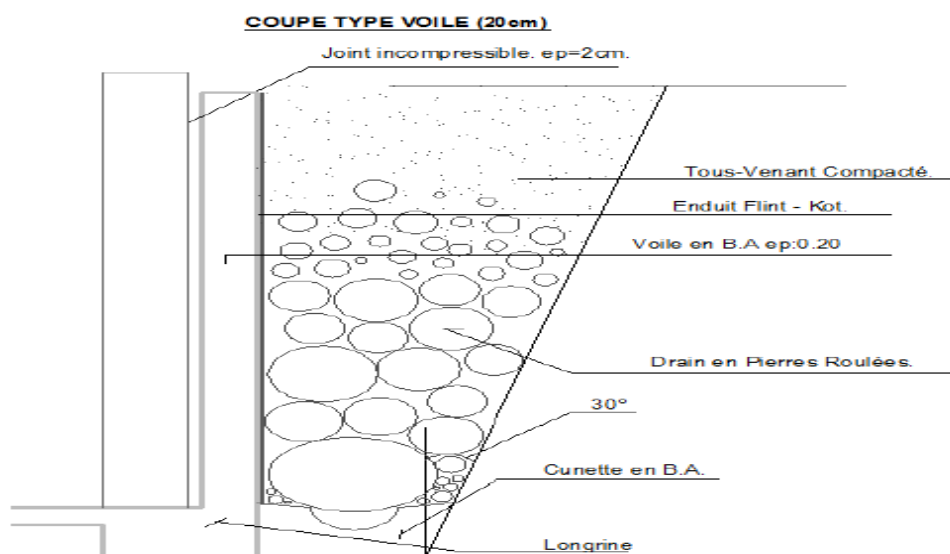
Schéma du mur plaque - Vue en élévation
